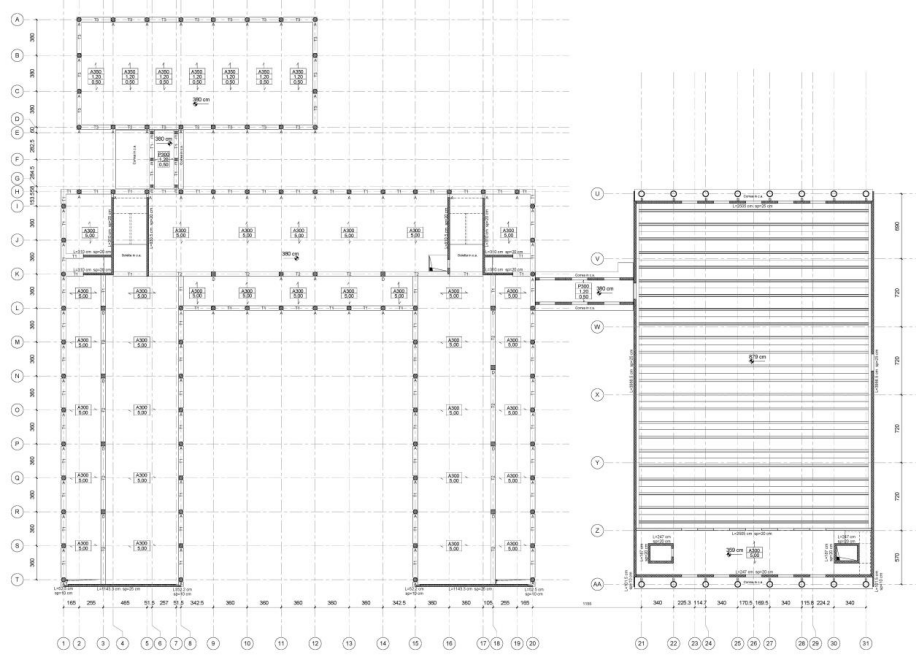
Edificio A: Vista speculare impalcato piano primo
